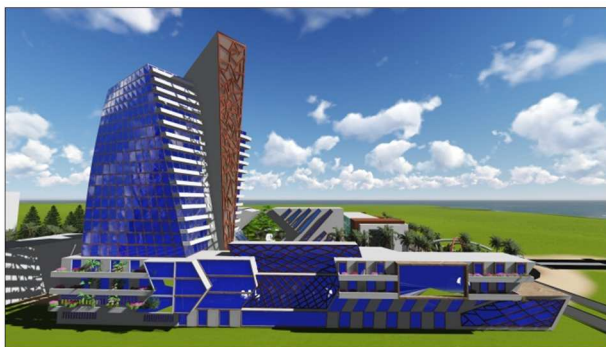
Vue sur la façade Nord qui donne sur le patio
